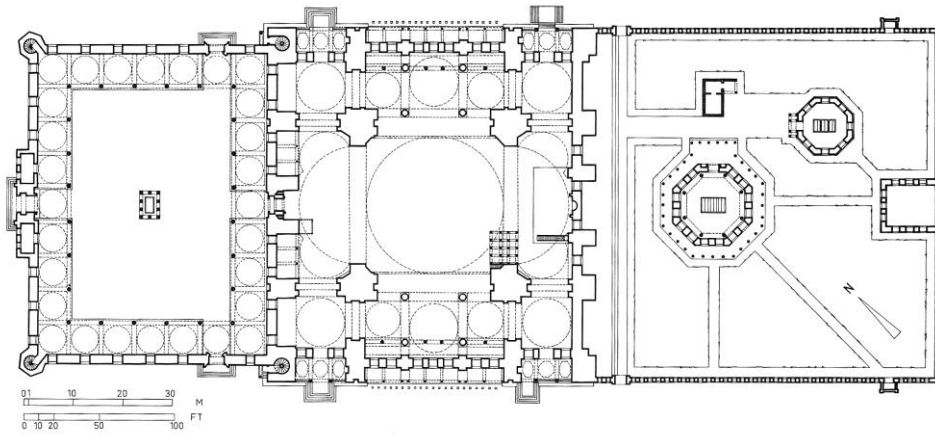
Grundriss, Süleymaniye Komplex, 1550-1557, Istanbul, Türkei.
